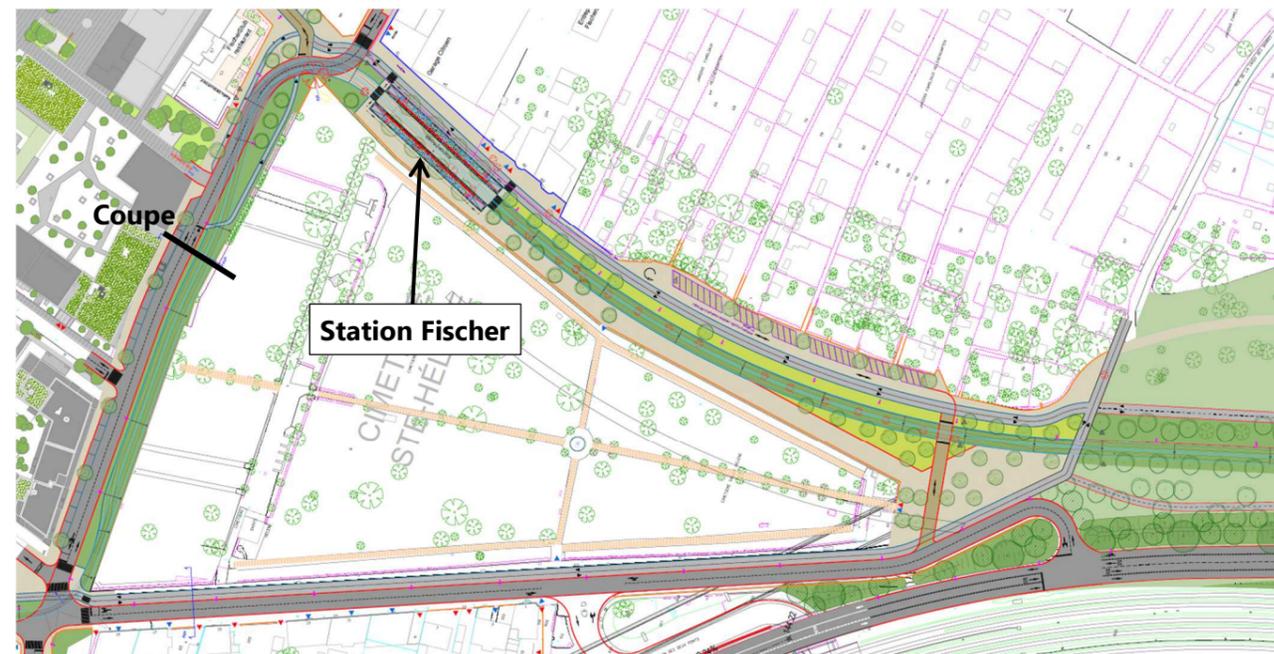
Plan de la route de Bischwiller et rue Hélène Schweitzer (source : AVP, GETAS 2023)
